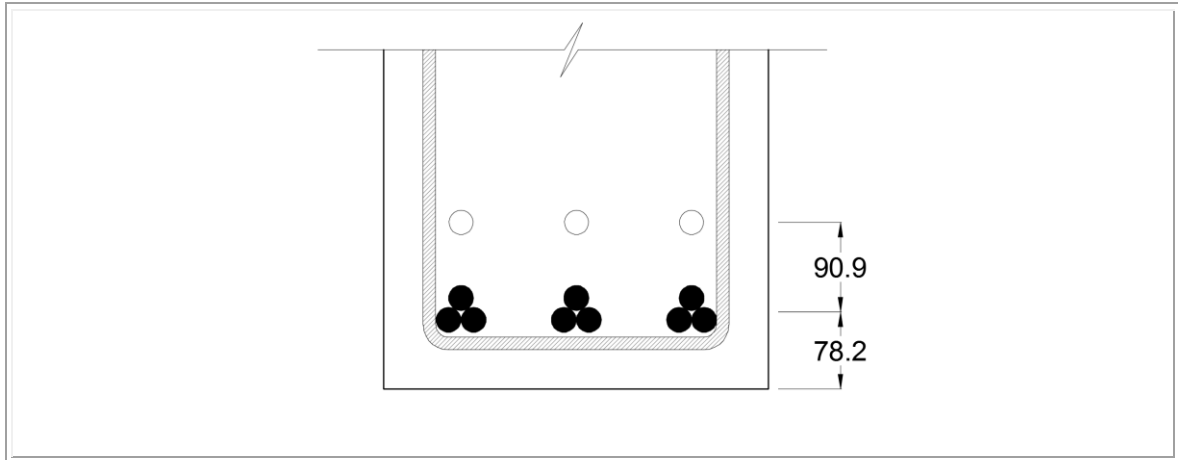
Centroide del refuerzo a 2,5 m del apoyo para 12 barras
